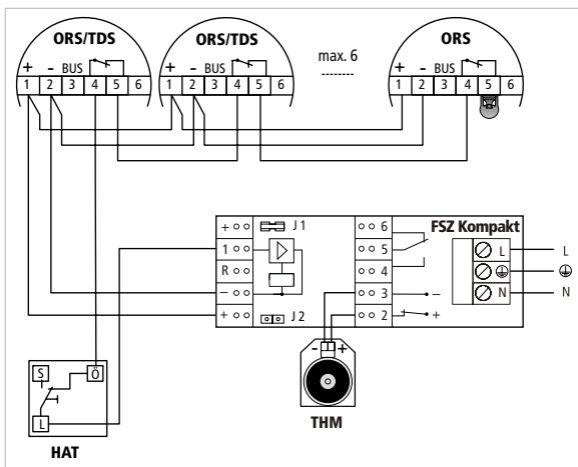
Anschluss mit Feststellvorrichtung, Handauslösetaster und externen Brandmeldern
